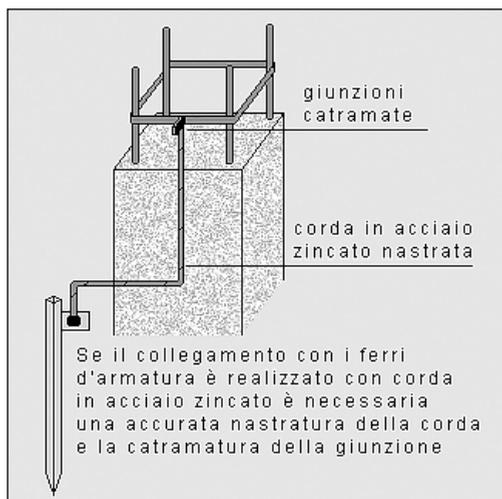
Collegamenti anti-corrosione dei ferri di armatura
